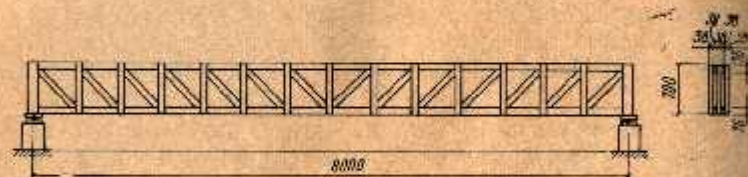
Схема дощатой фермы с параллельными поясами пролетом 8 м
